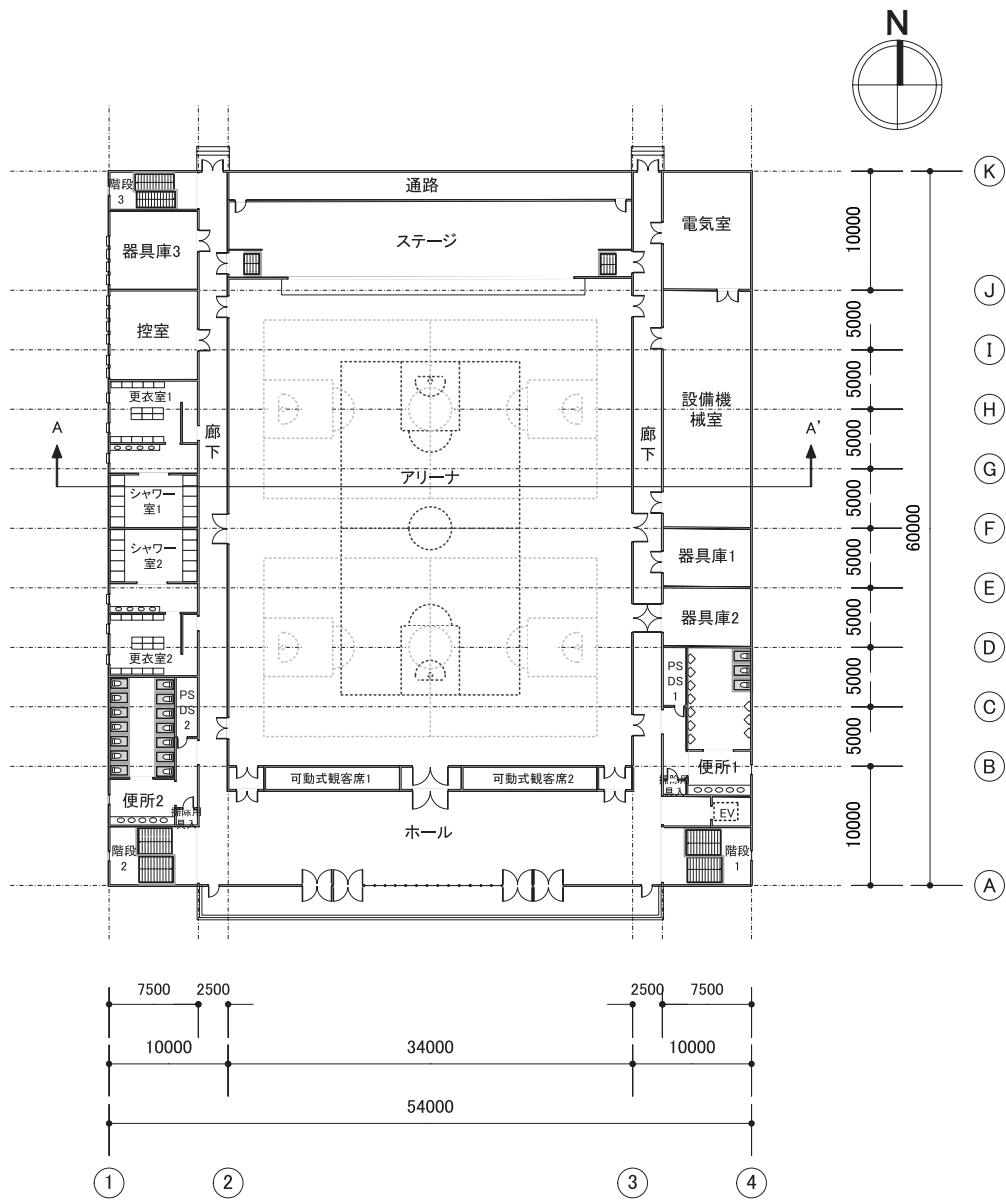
A.25 モデル建物（学校等・講堂、5,000m<sup>2</sup>） 1階平面図
